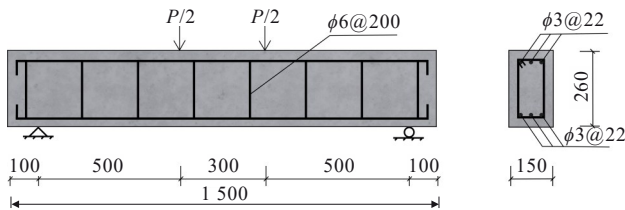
试验梁尺寸及钢筋布置图(单位:mm)
